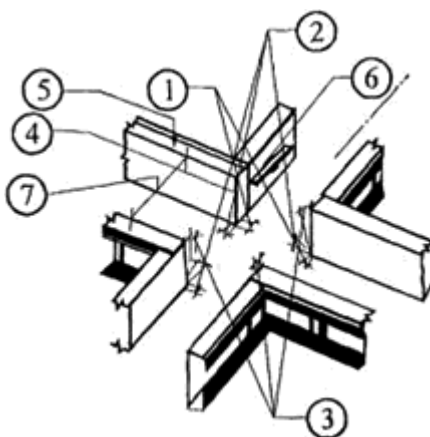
Предельные отклонения при устройстве опалубки для монолитного ростверка
